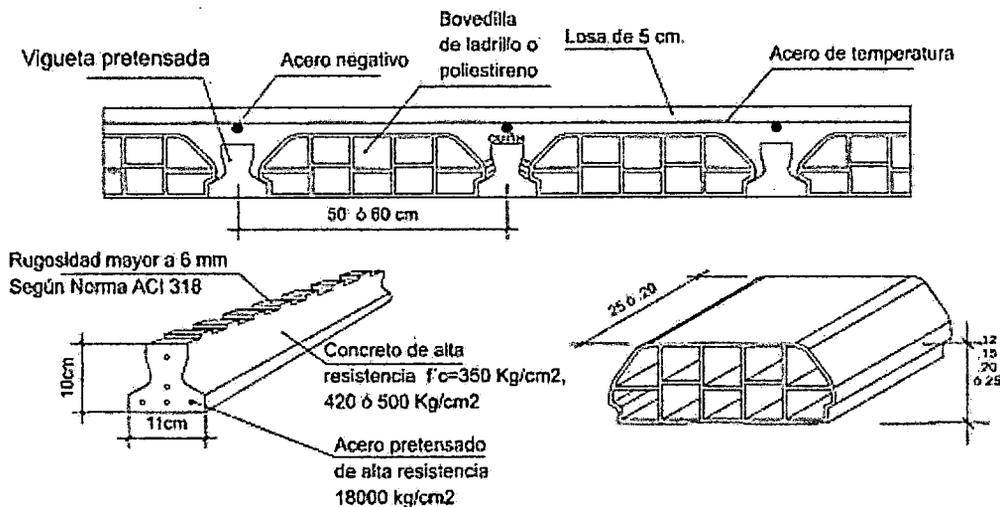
, Sección Transversal Losa Firth. Fig. 6, Vigueta Firth.
